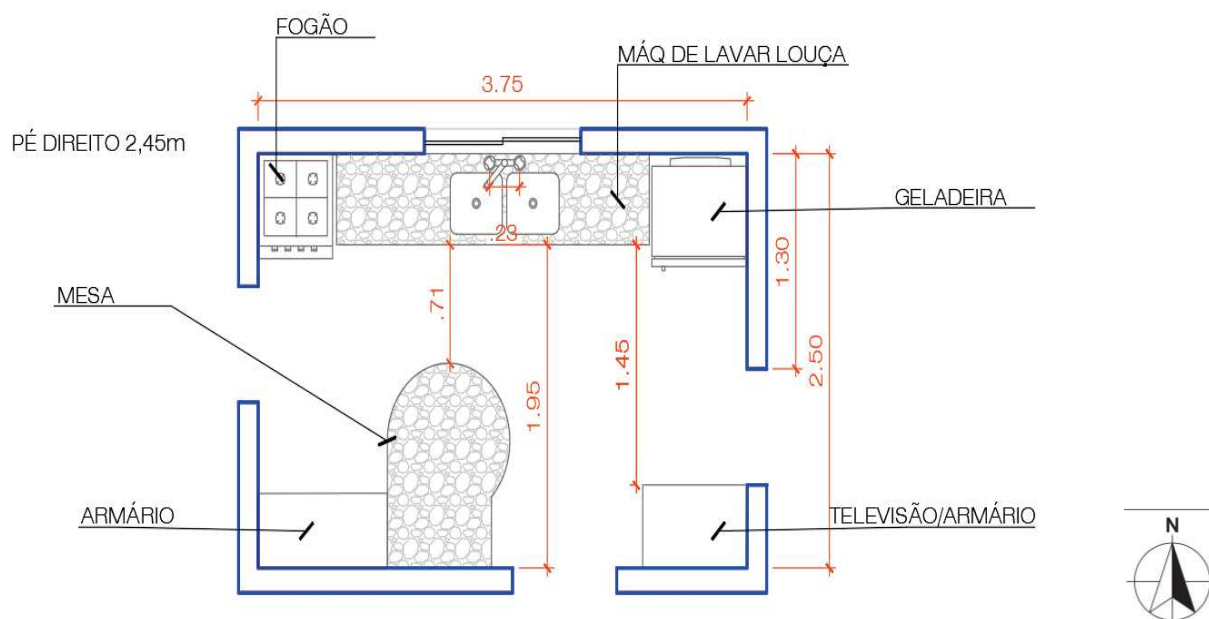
Planta baixa com medidas da cozinha residencial, sem escala.
